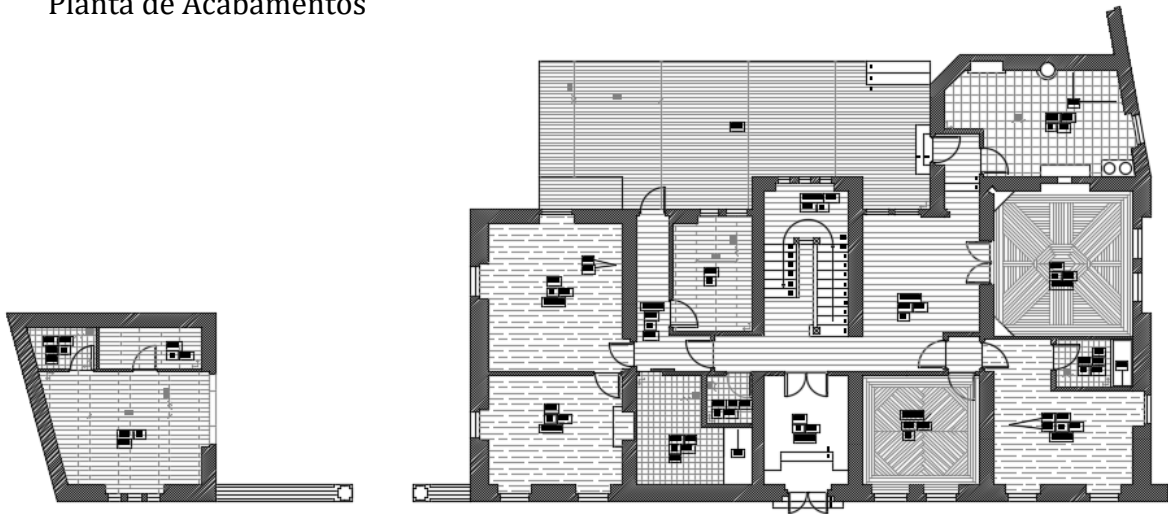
Planta de Acabamentos, Piso do Rés-do-Chão
